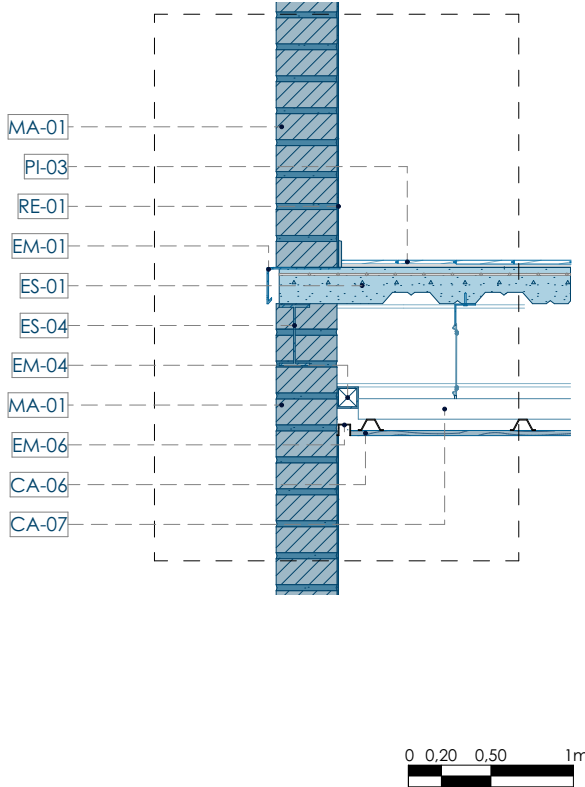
Detalle constructivo 02. Nota. Elaboración propia.
